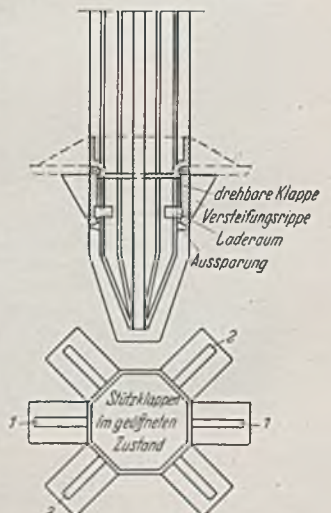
Spitze des Explosionspfahles im Querschnitt.
